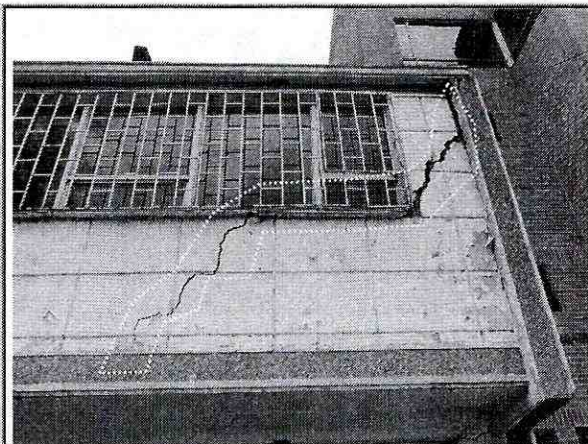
Se observan grietas sobre el muro de fachada del segundo piso.
